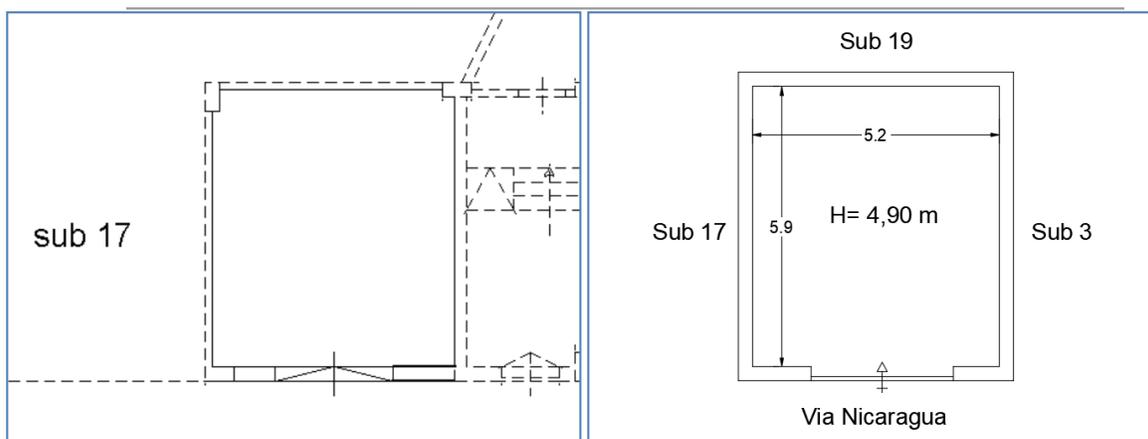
Confronto tra la Planimetrica catastale (stralcio a sx) e restituzione grafica dello stato dei luoghi (a dx)
